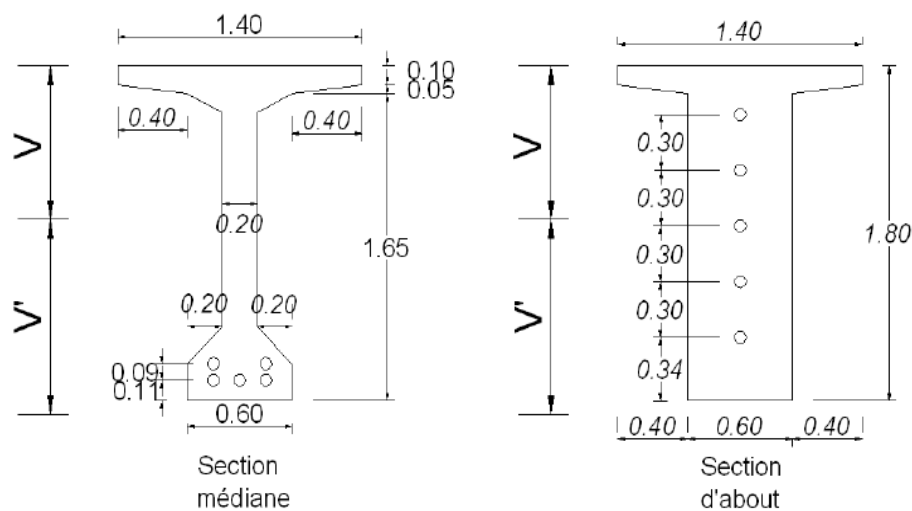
L'emplacement des câbles dans les sections de la poutre
